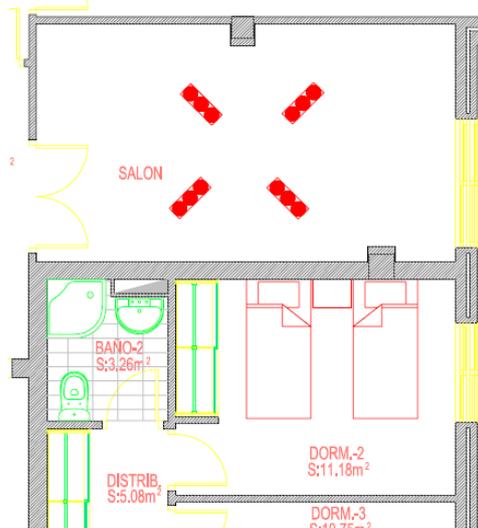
Plano de Planta de los recintos a estudio en el Edificio 1
